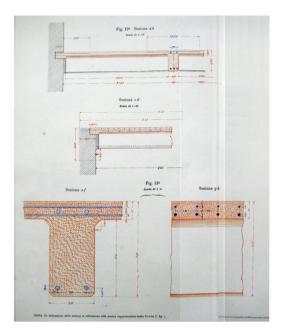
A sinistra, il solaio del locale a piano terra del laboratorio della Caserma Specialisti a Prati di Castello, realizzato in cemento armato secondo il sistema Caveglia; sezioni delle travi e della soletta. A destra, un secondo solaio avente le stesse dimensioni, costruito tenendo conto della solidarietà tra le travi e la soletta; sezioni delle travi e della soletta (Ispettorato delle costruzioni del Genio, 1901).
